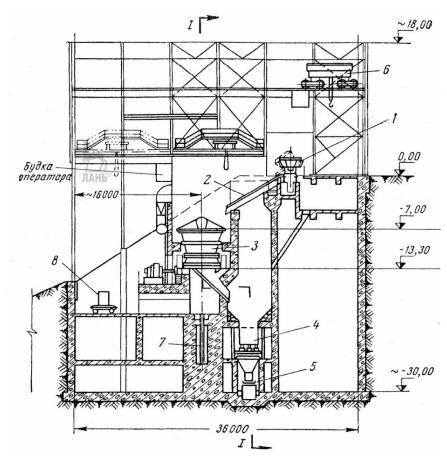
Корпус крупного дробления с конусной дробилкой ККД: 1 – саморазгружающийся вагондумпкар; 2 – колосниковый грохот; 3 – конусная дробилка крупного дробления; 4 – пластинчатый питатель; 5 – конвейер ленточный; 6 – кранмостовой; 7 – гидравлический подъемник; 8 – тележка с эксцентриком
